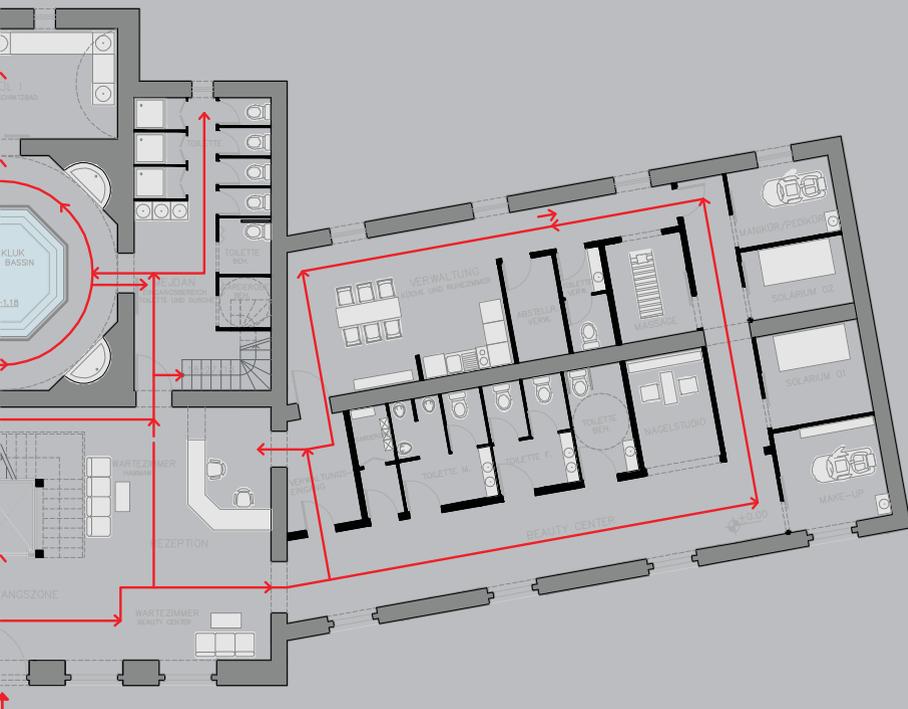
Grundriss Erdgeschoss\_Gehlinie
